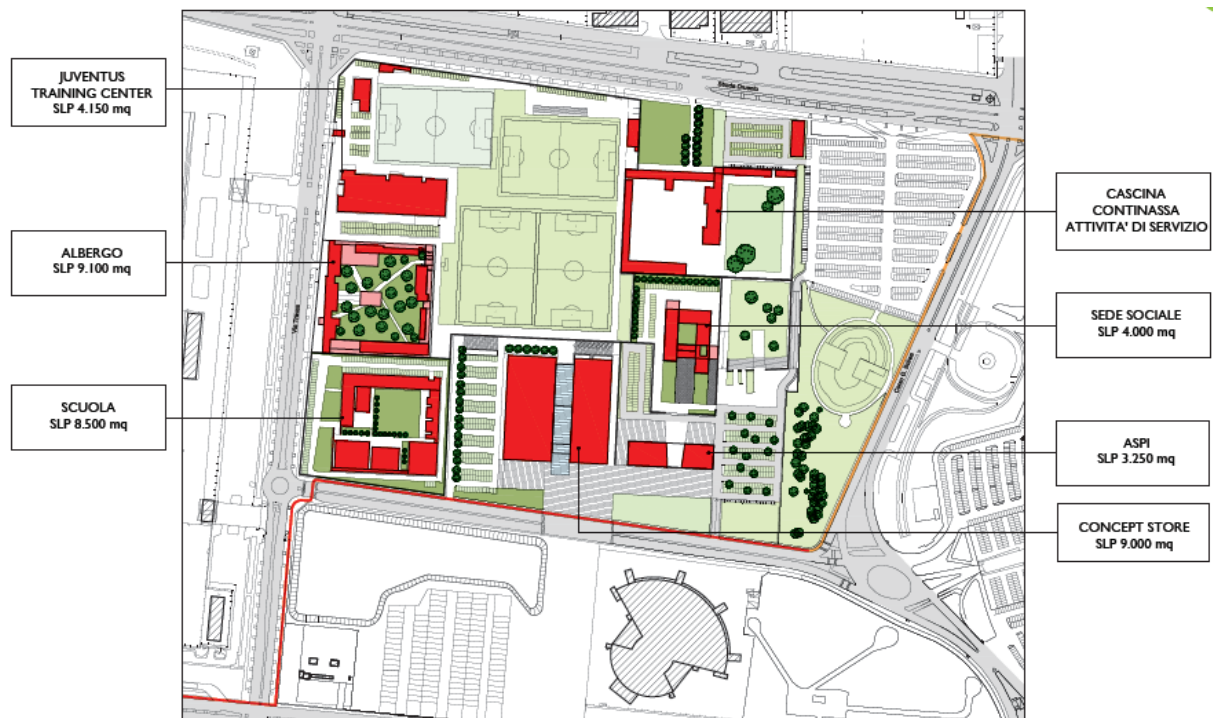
Stralcio del Planivolumetrico – PEC luglio 2014
